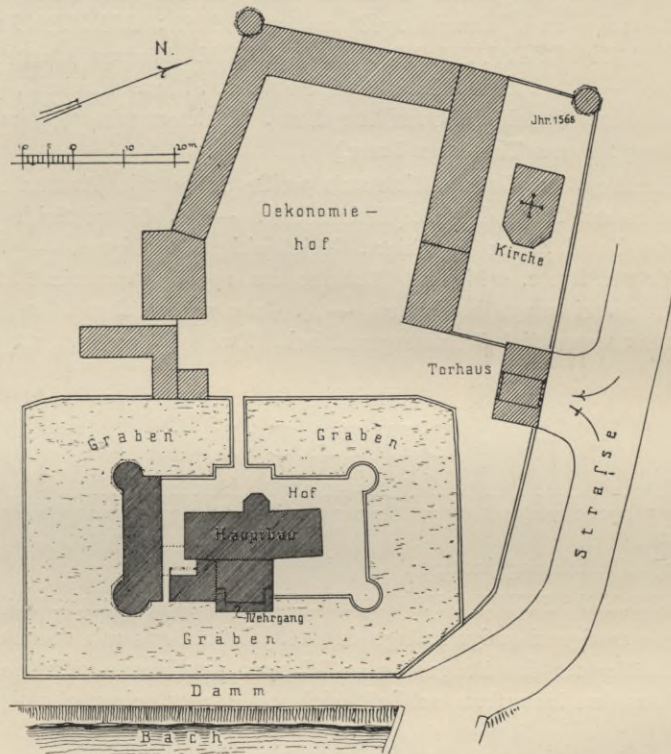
Ebelsbach. Lageplan des Schlosses.
